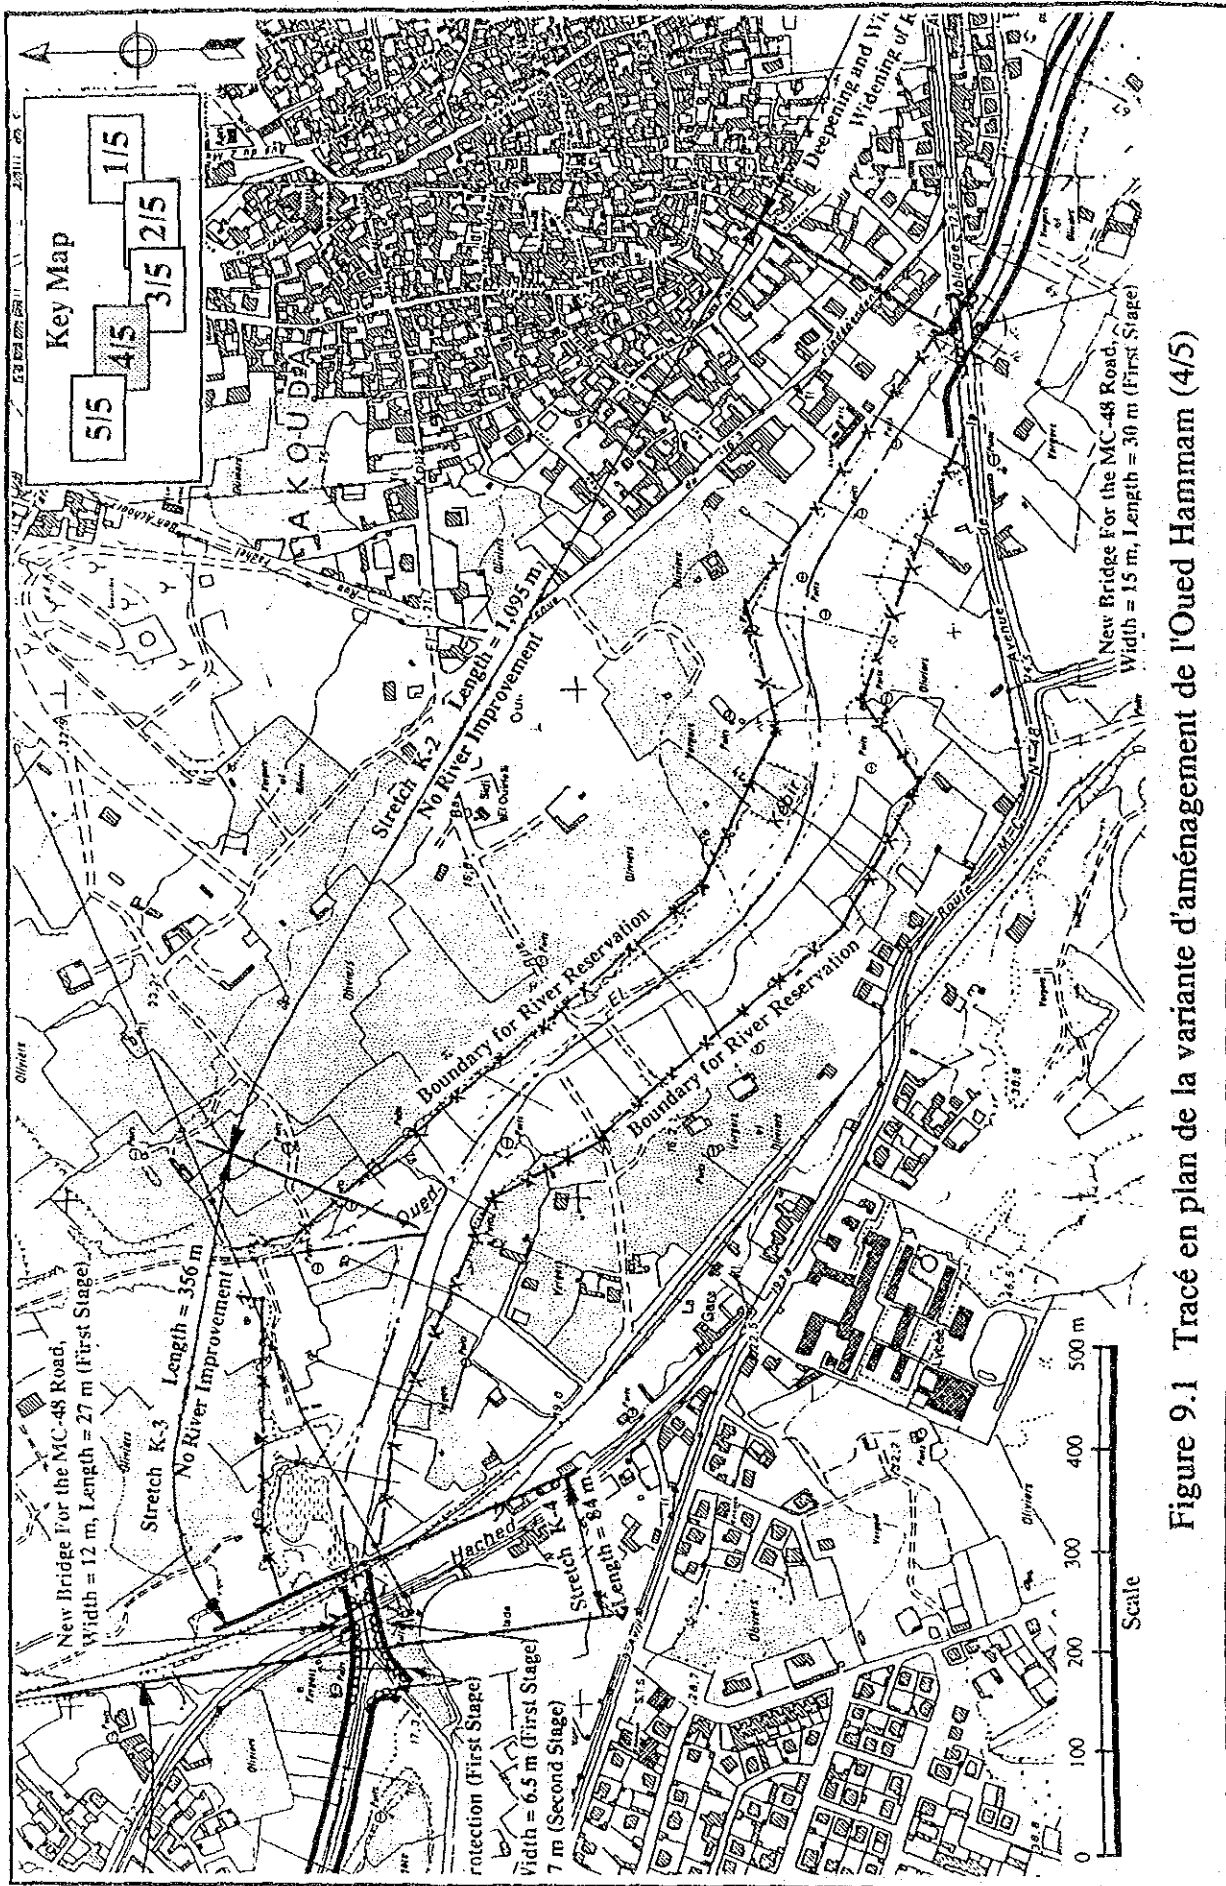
Tracé en plan de la variante d'aménagement de l'Oued Hammam (4/5)
